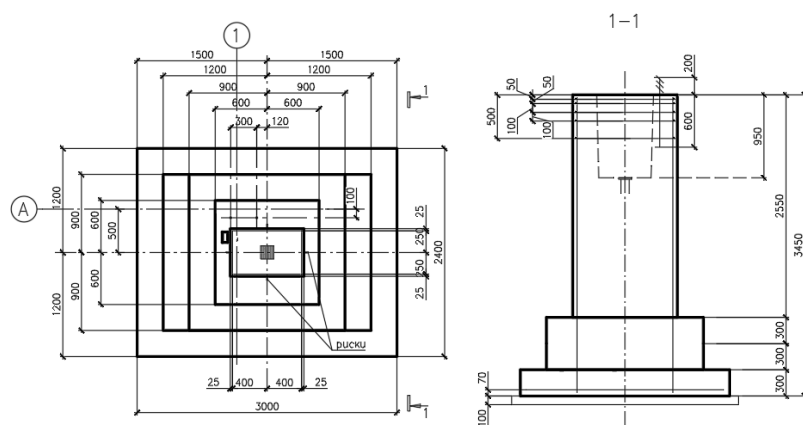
Фундамент монолитный ФМ-2 (3х2,4 м)
